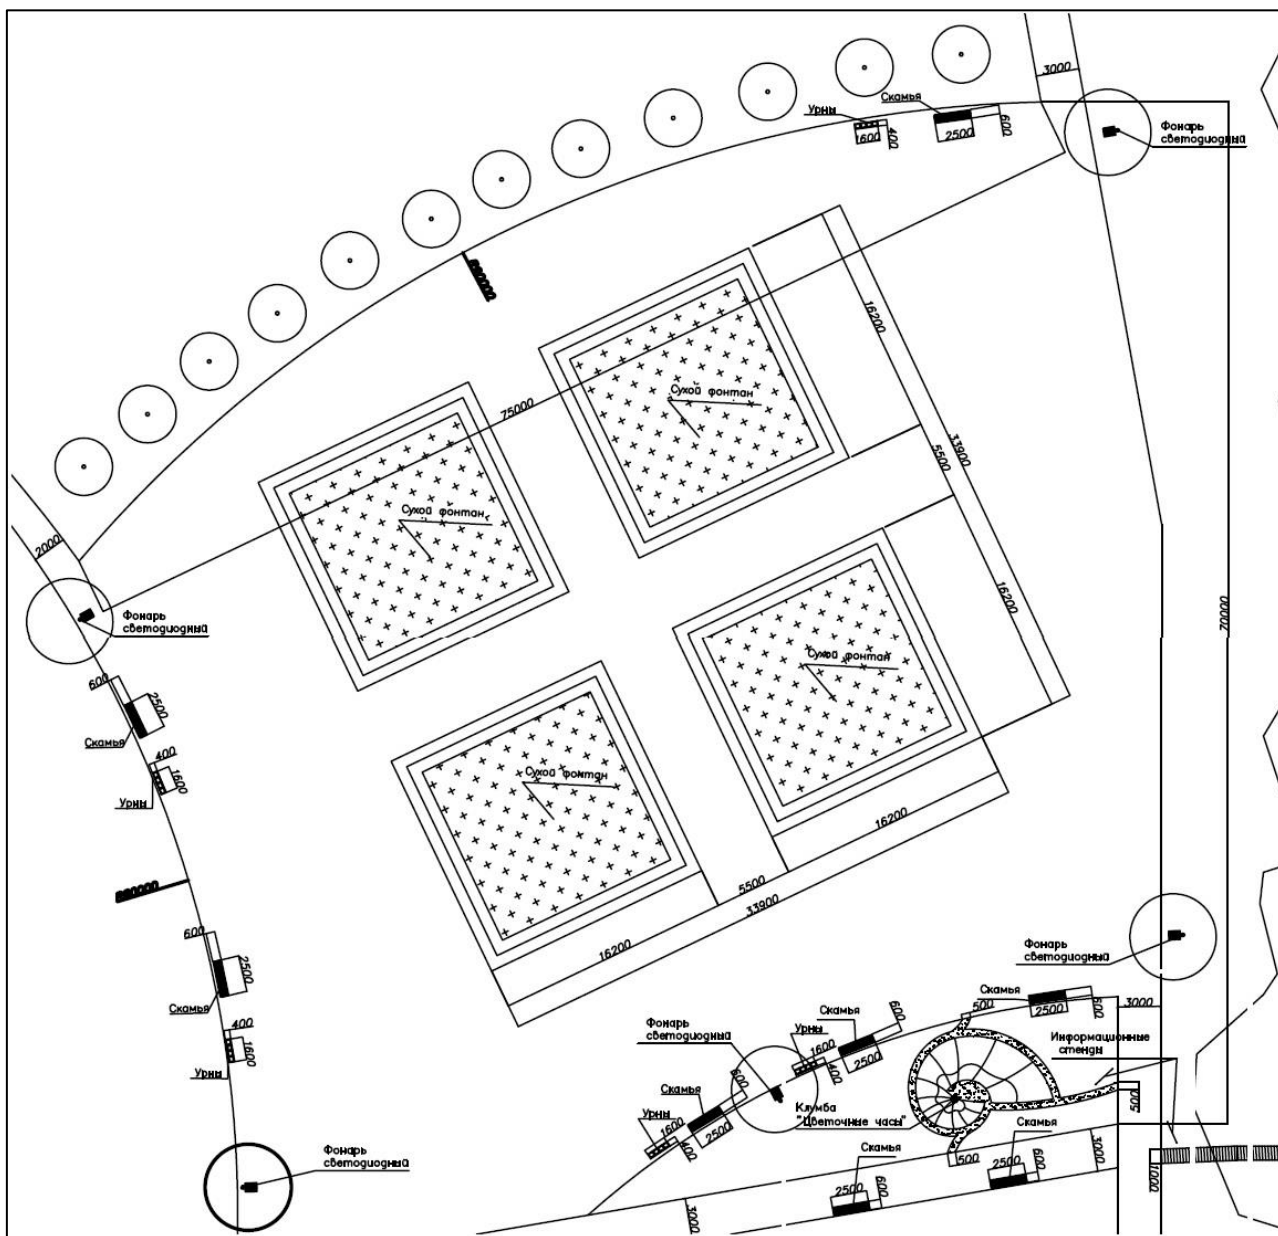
Фрагмент генплана 11, площадка с сухим фонтаном
